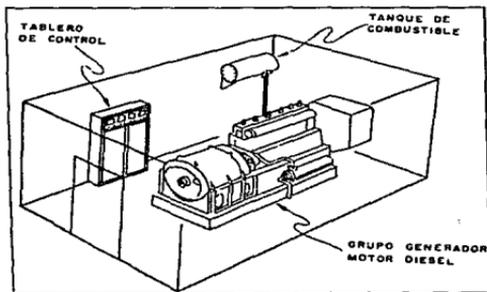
Vista de los elementos de una planta eléctrica de emergencia.
